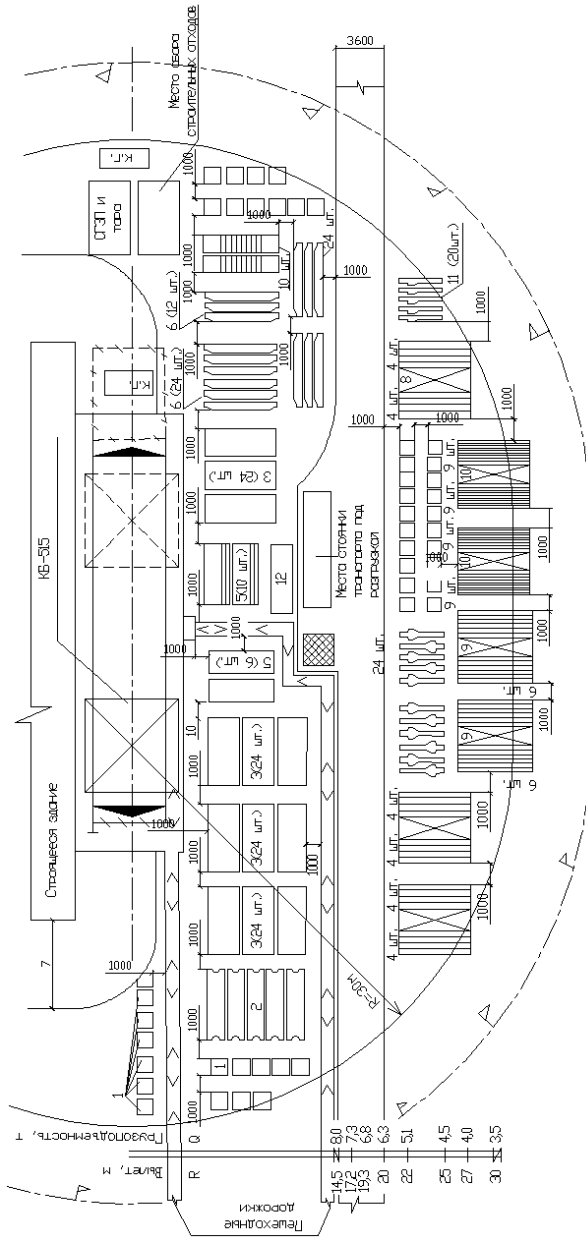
Примерный план размещения грузов на объектном складе при монтаже здания башенным краном:
